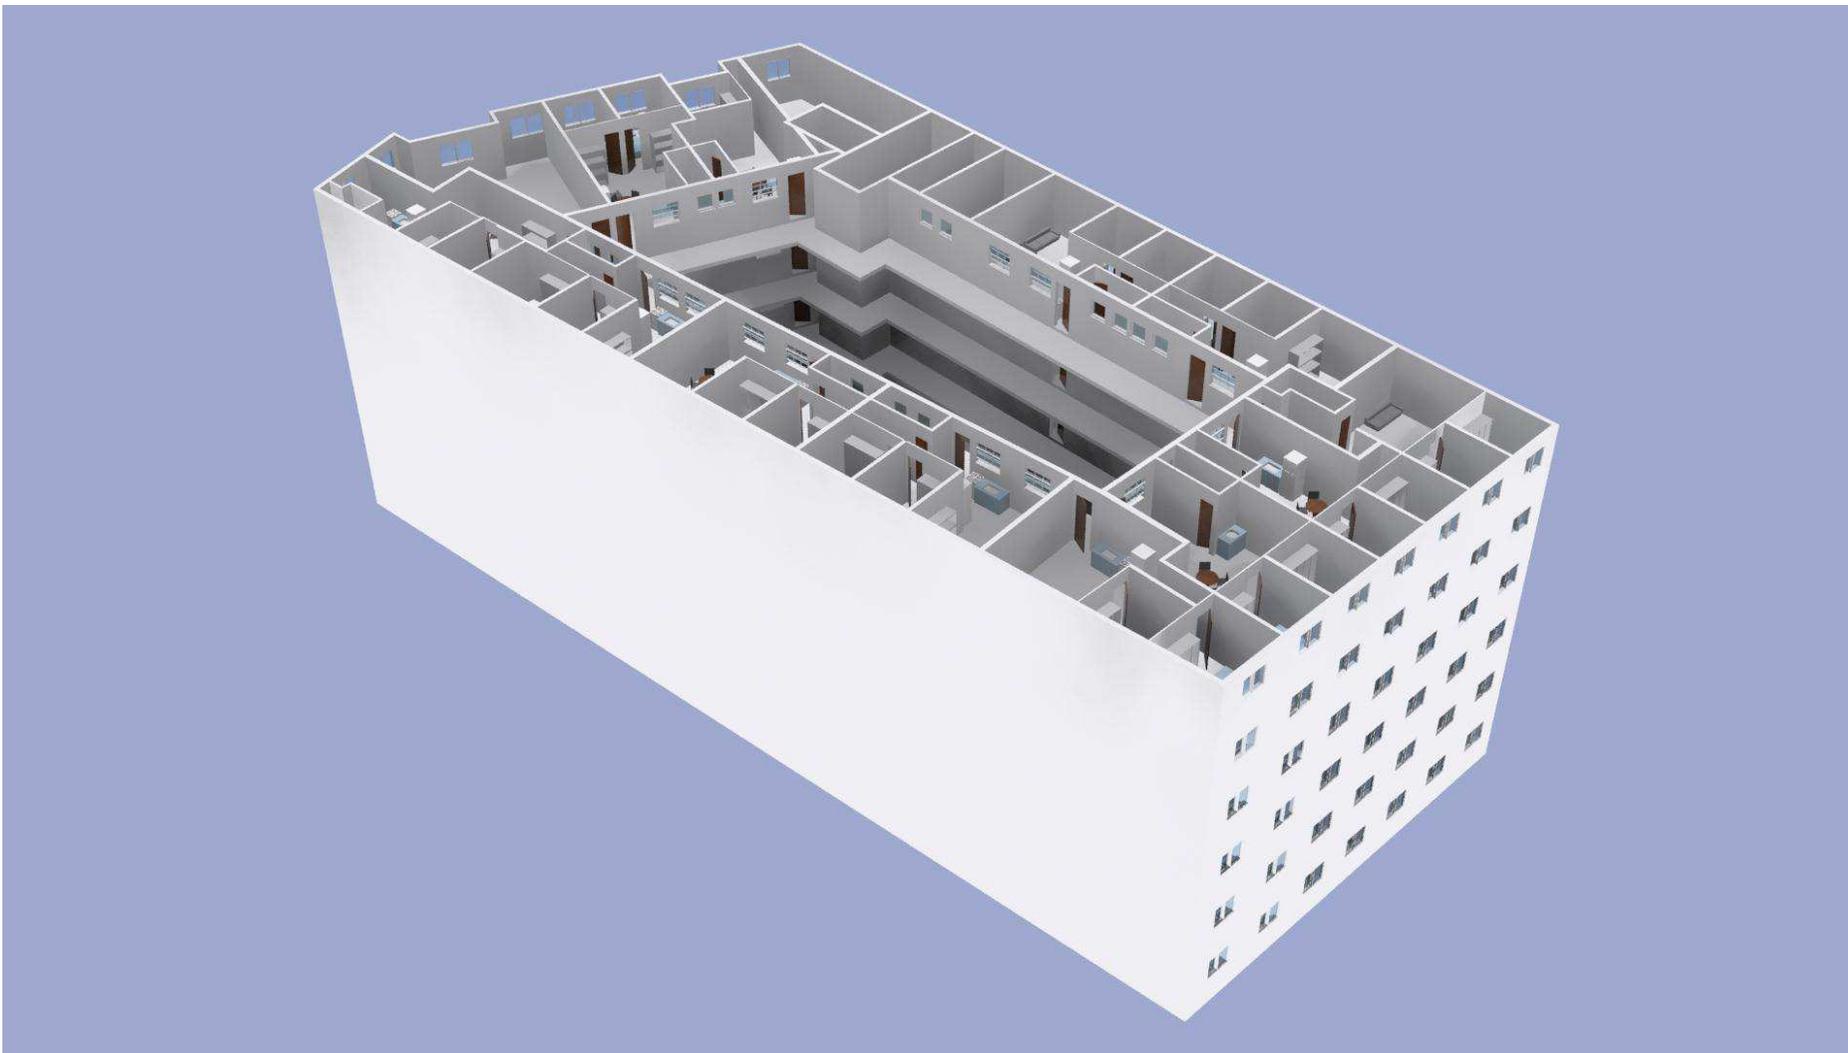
vista 3D do prédio. Vista da fachada posterior.
